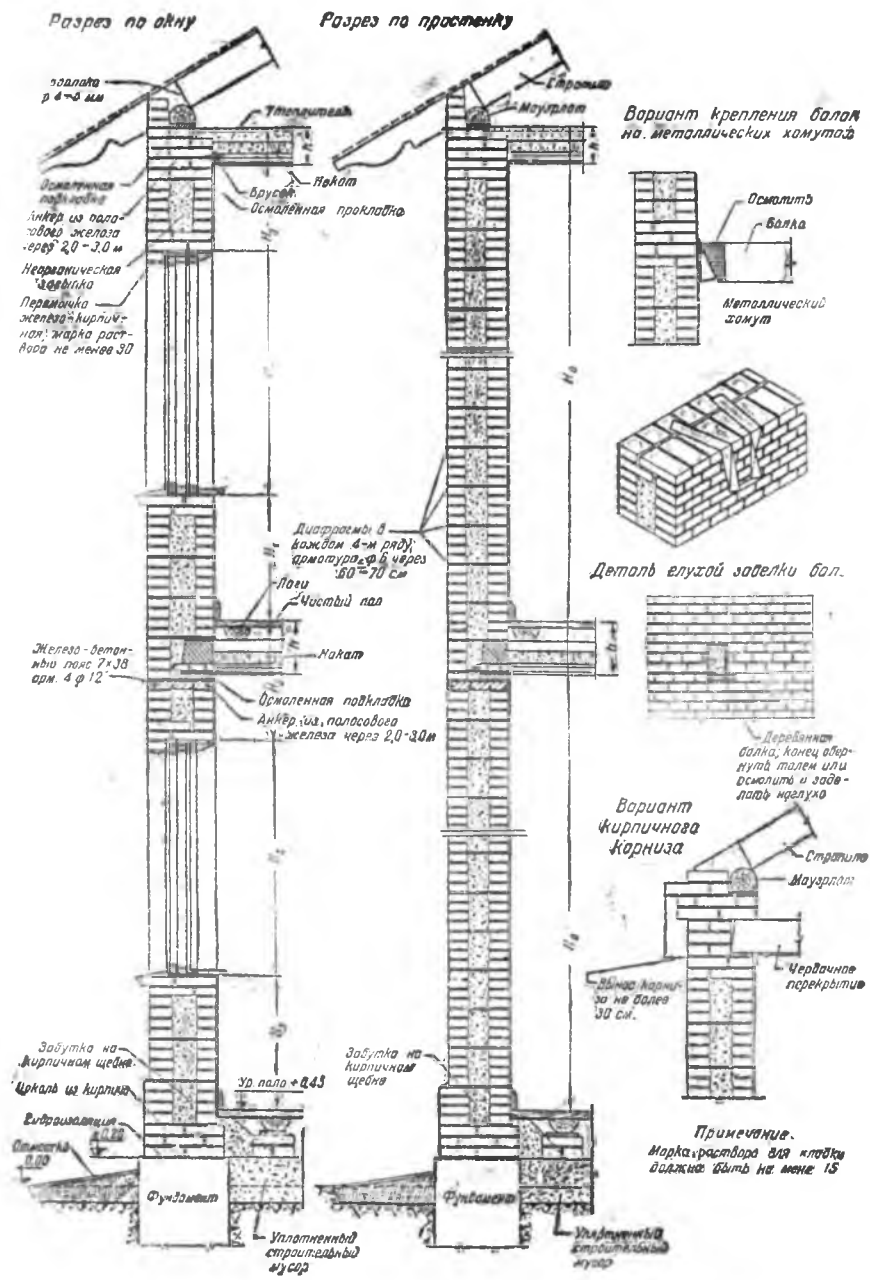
Кирпичезасыпные стены. Разрезы по двухэтажной стене. Детали опирания балок
